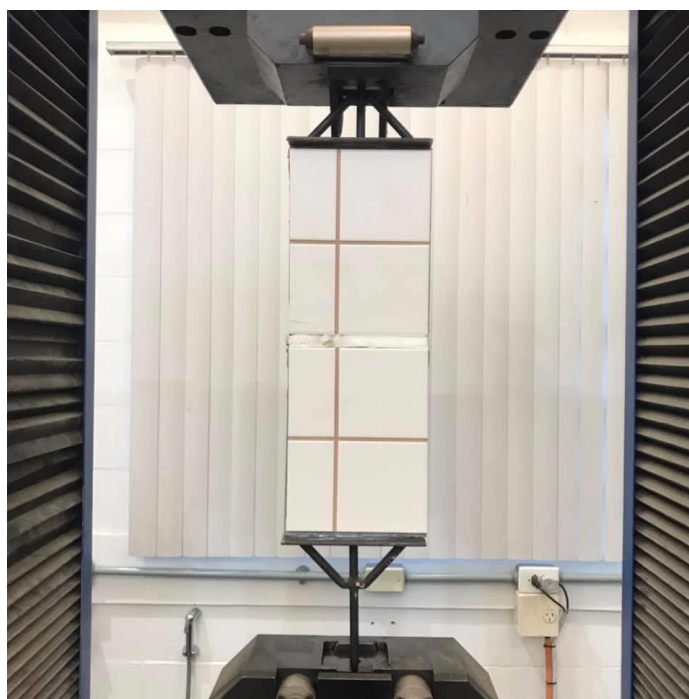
Máquina de ensaio universal preparada para ensaio de tração
